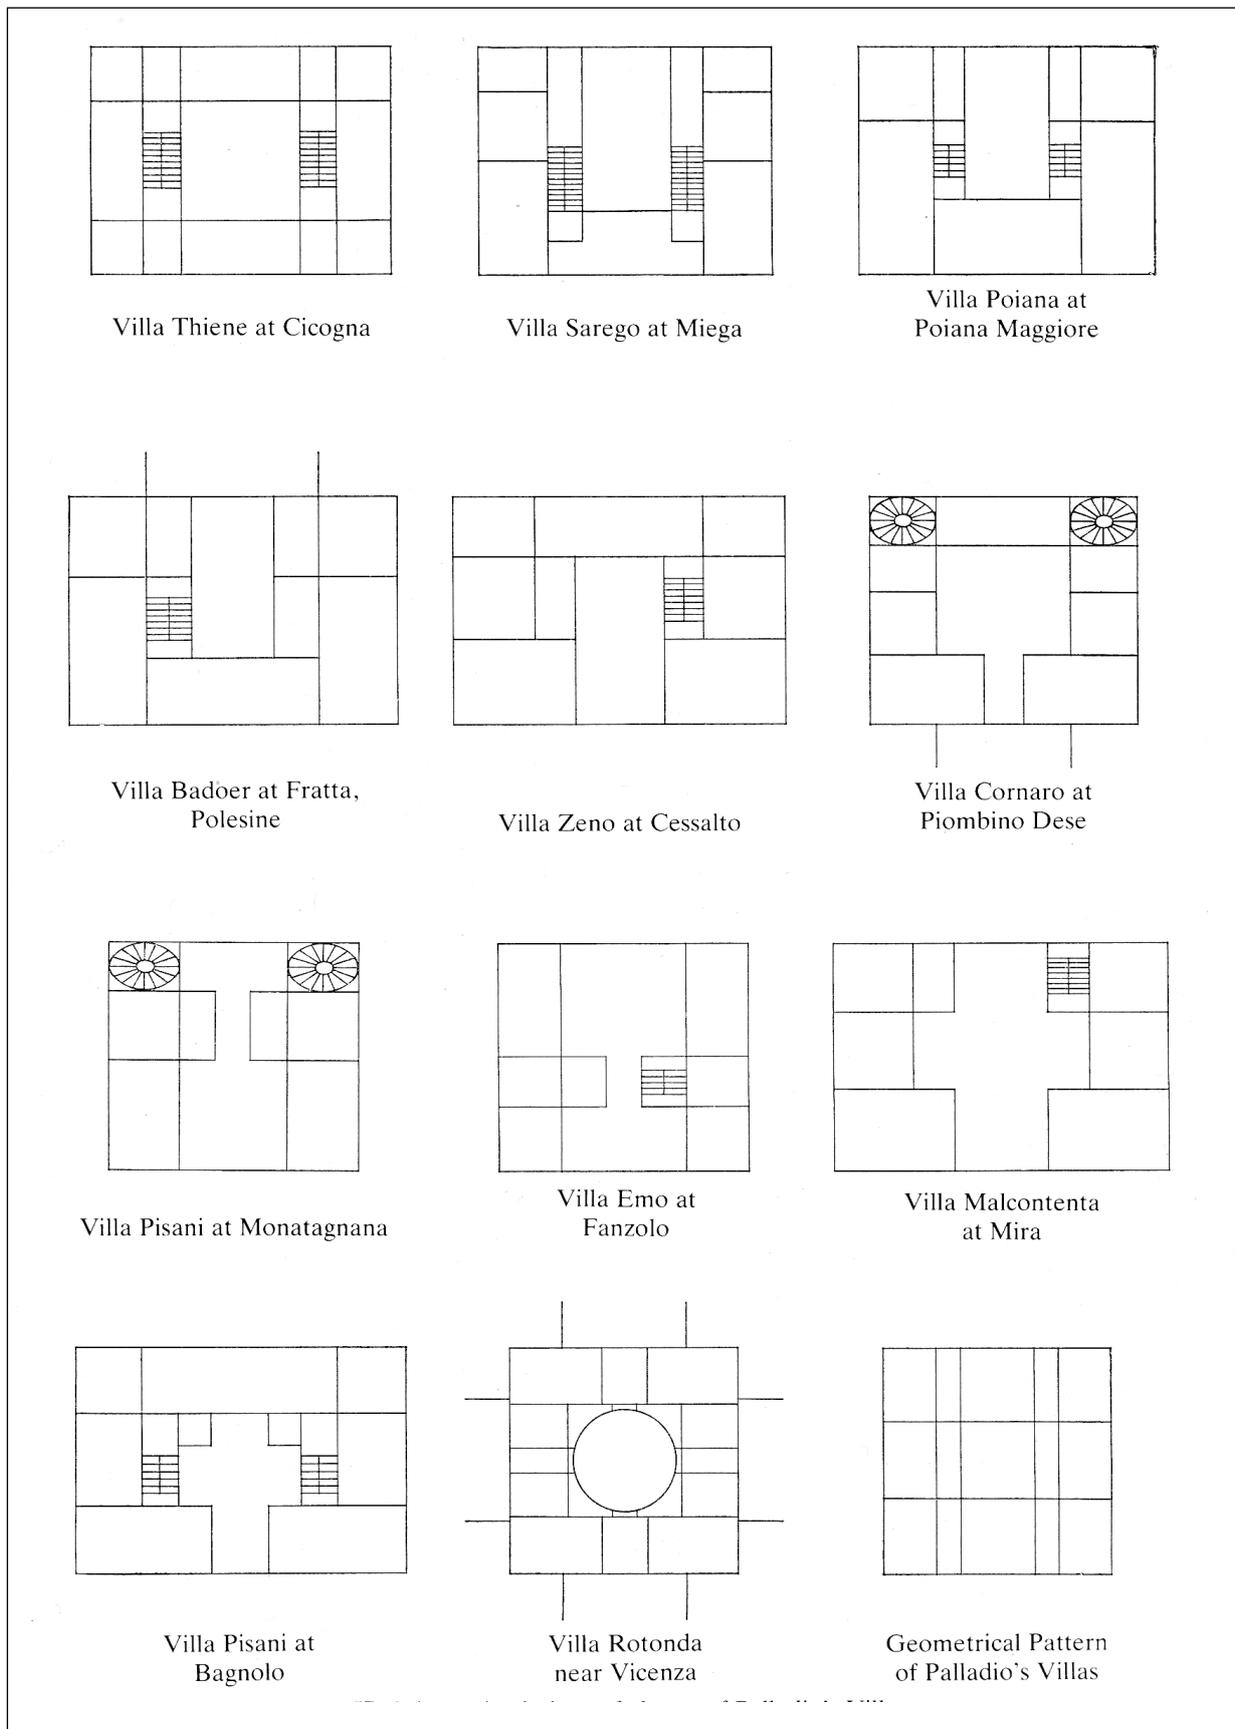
esquemas de plantas de vilas palladianas conforme WITTKOWER. Fonte: WITTKOWER, 1988.
